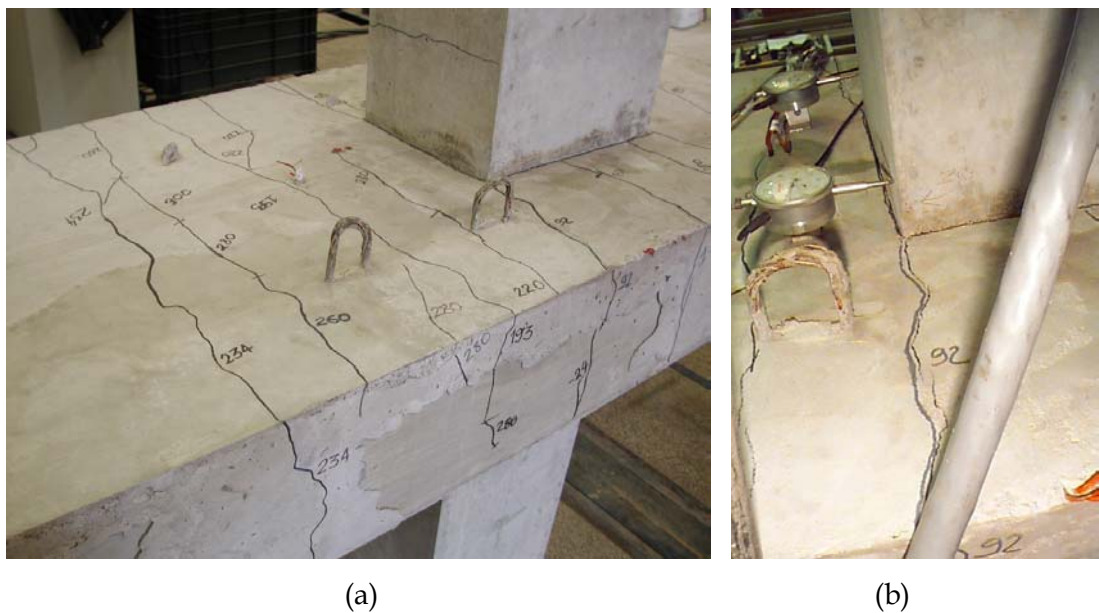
Configuração das fissuras na vista superior do modelo.
